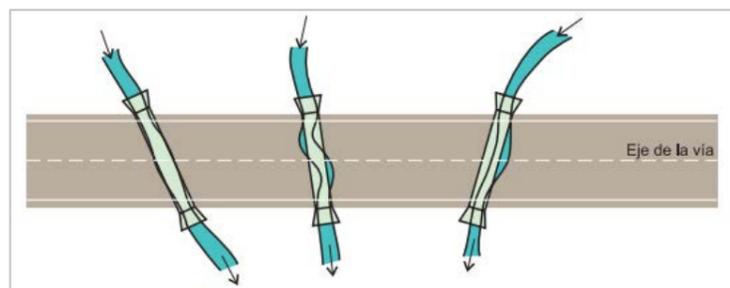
Situación coincidente con cauce natural. Fuente: 5.2-IC Drenaje
